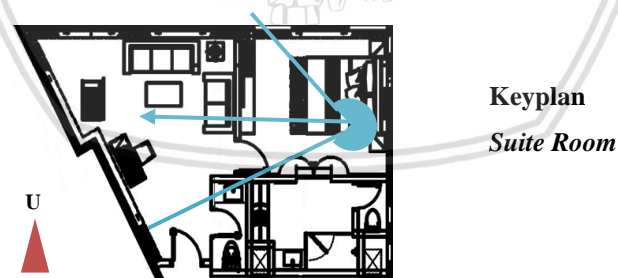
Dimensi Fasade dan Tampilan pada Denah; Rekomendasi 2
